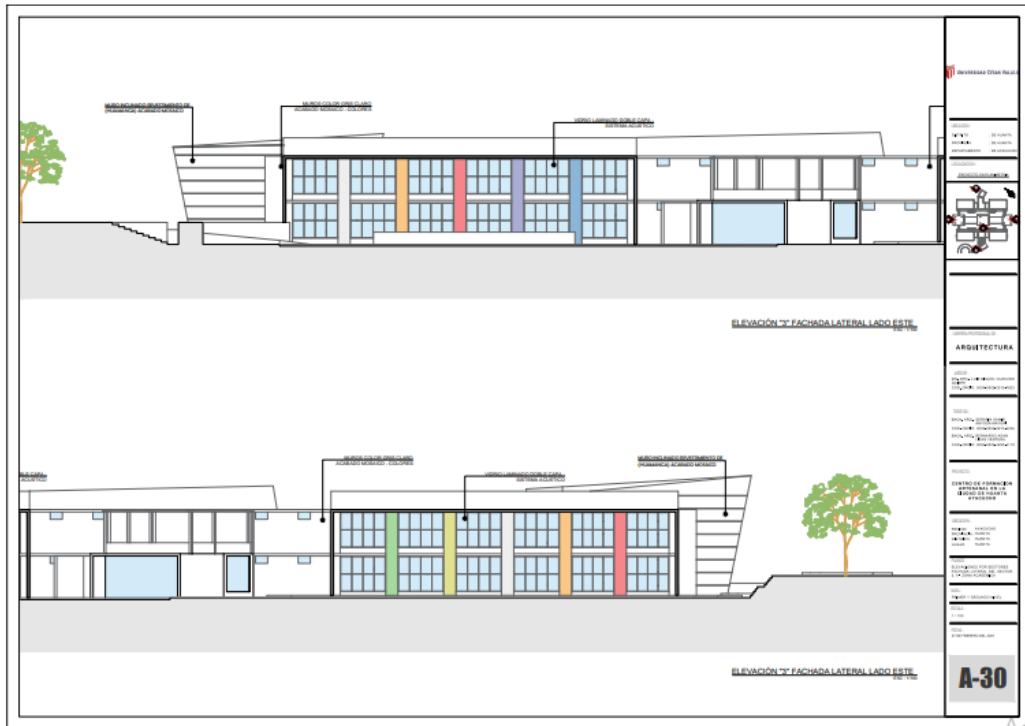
Elevaciones del lado este – fachada lateral izquierda escala 1/100.
